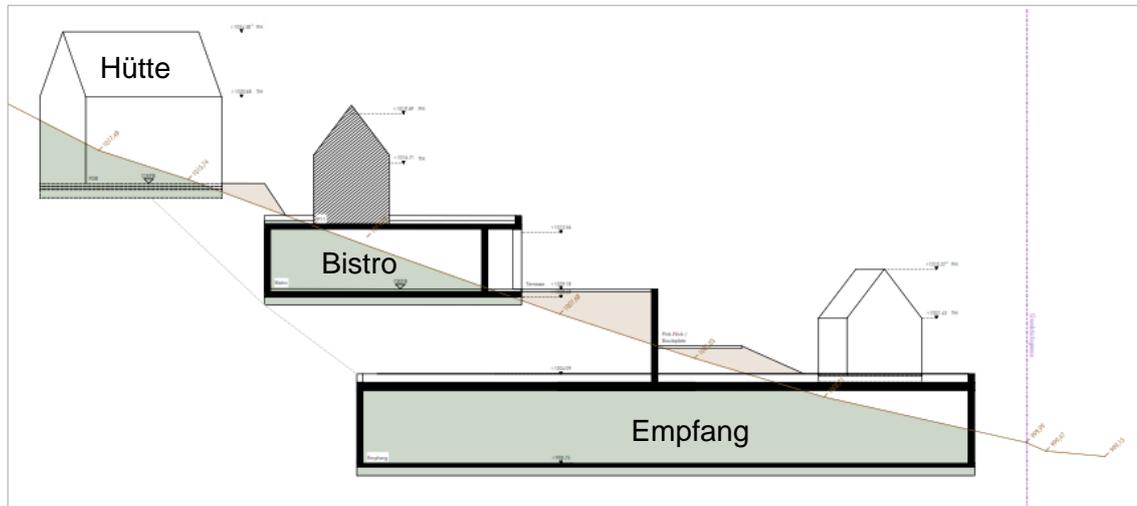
Schnitt durch die geplante Bebauung im Plangebiet durch das Empfangsgebäude und das Bistro (Quelle: Architekturbüro Sennrich & Schneider, Stand Oktober 2024)
